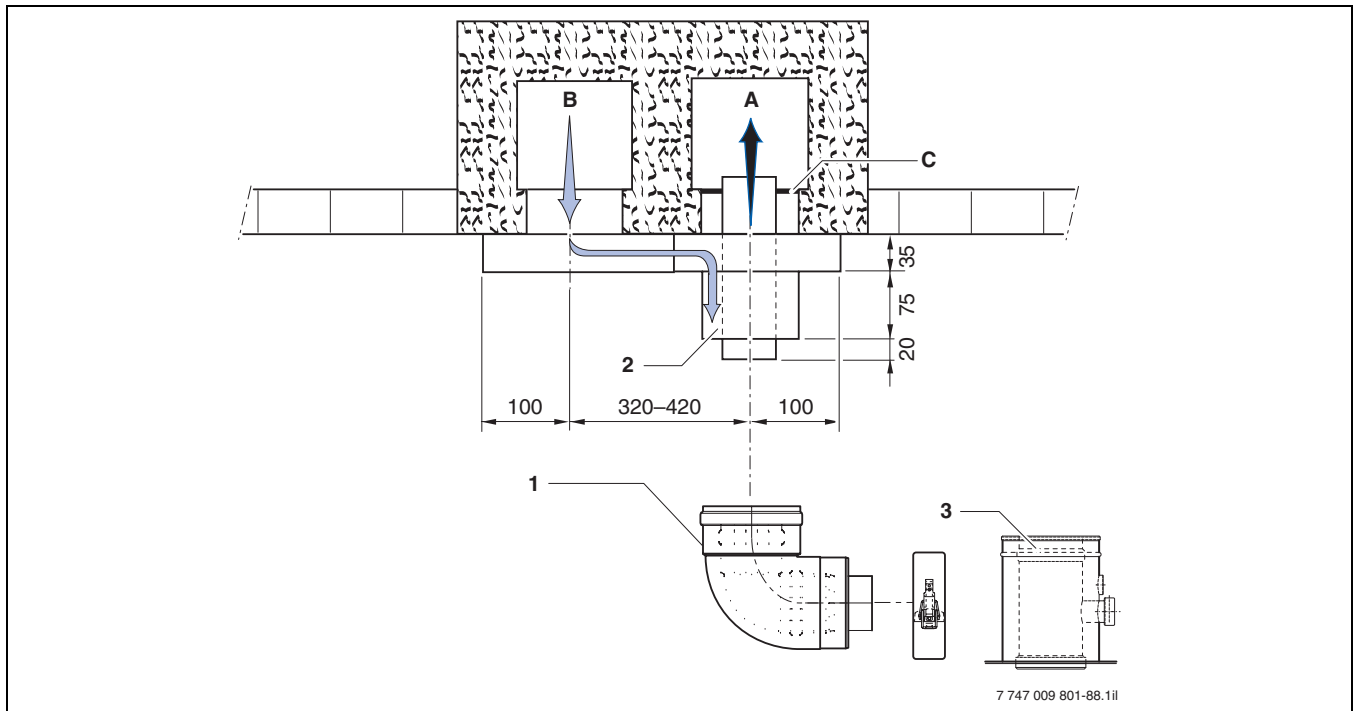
Bauteile des Grundbausatzes LAS-P für U152 (Maße in mm)
